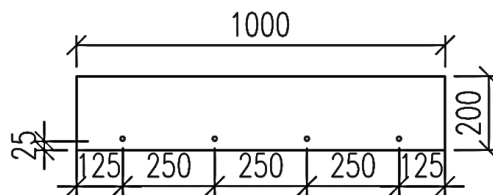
7: Esquema losa LCGFRP-102 (unidades: mm)
